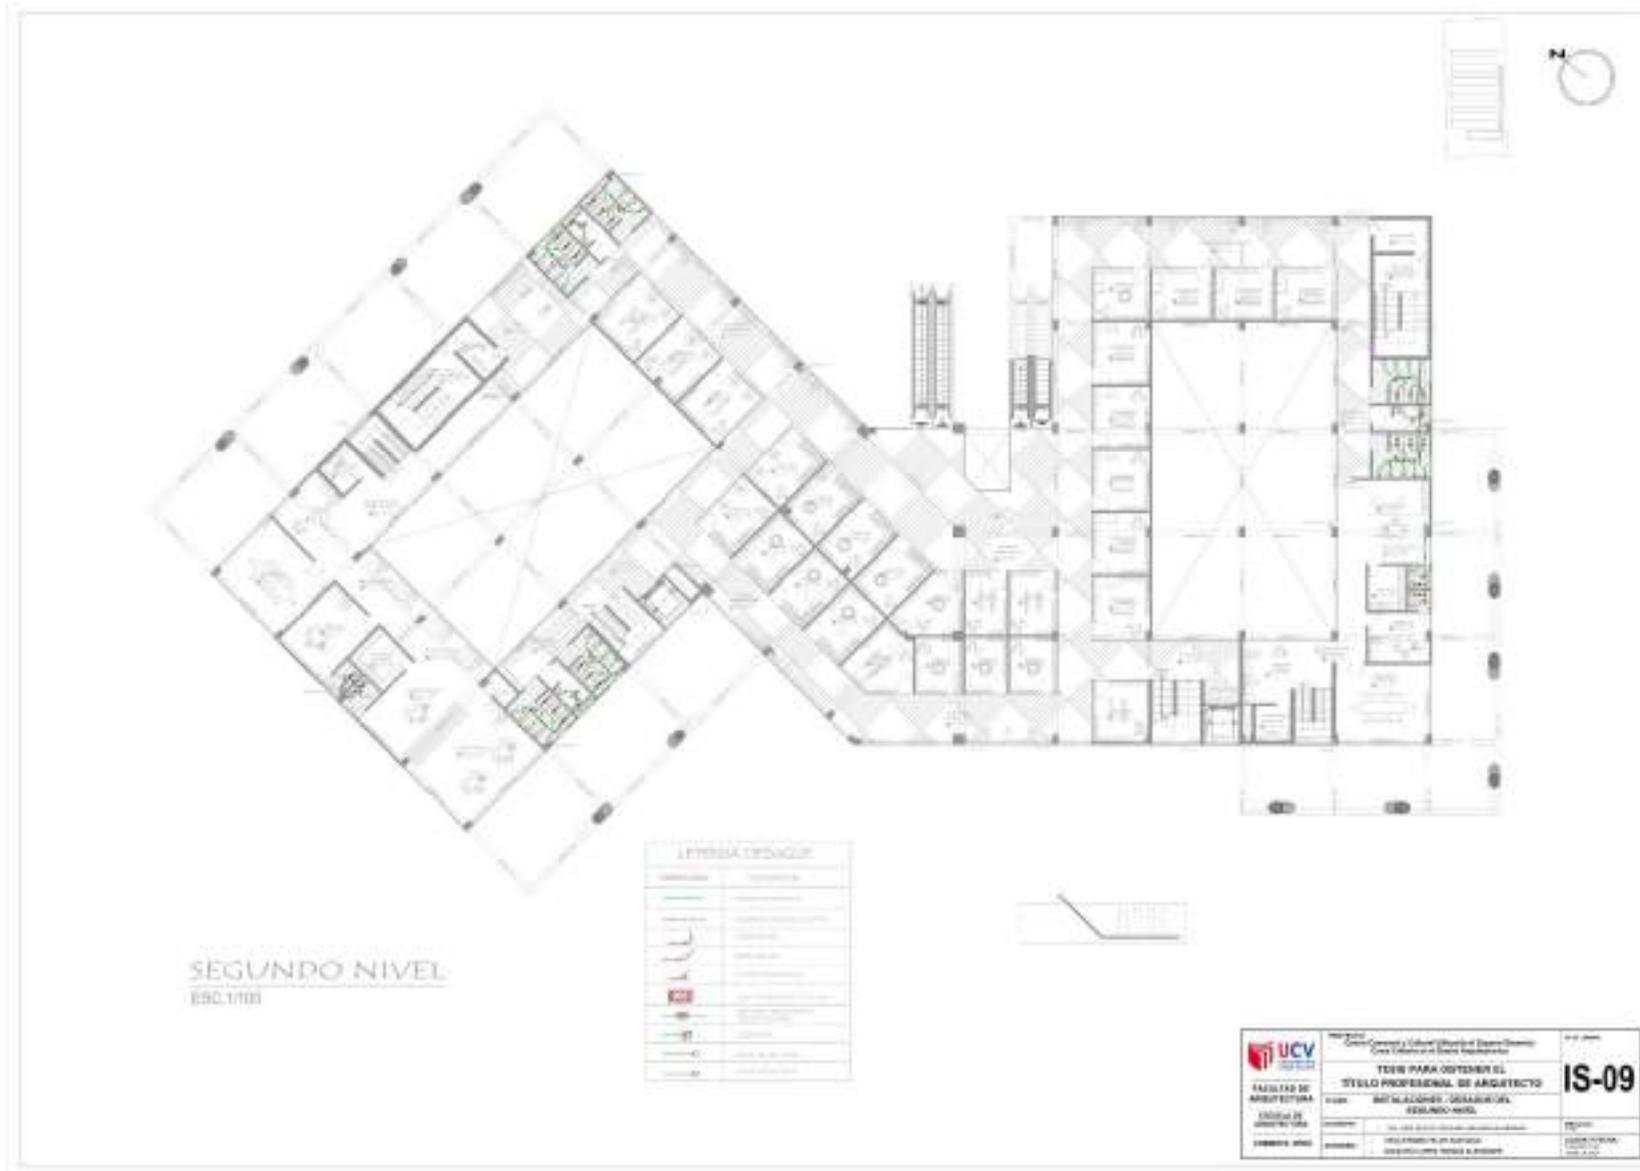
Plano de instalación de desagüe y pluvial segundo piso
